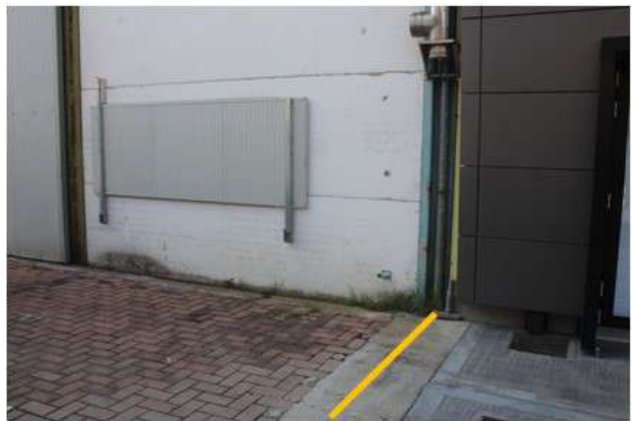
dettaglio confine lato est – solo il cambio di pavimentazione consente di individuare l'allineamento del confine di proprietà (linea gialla)
